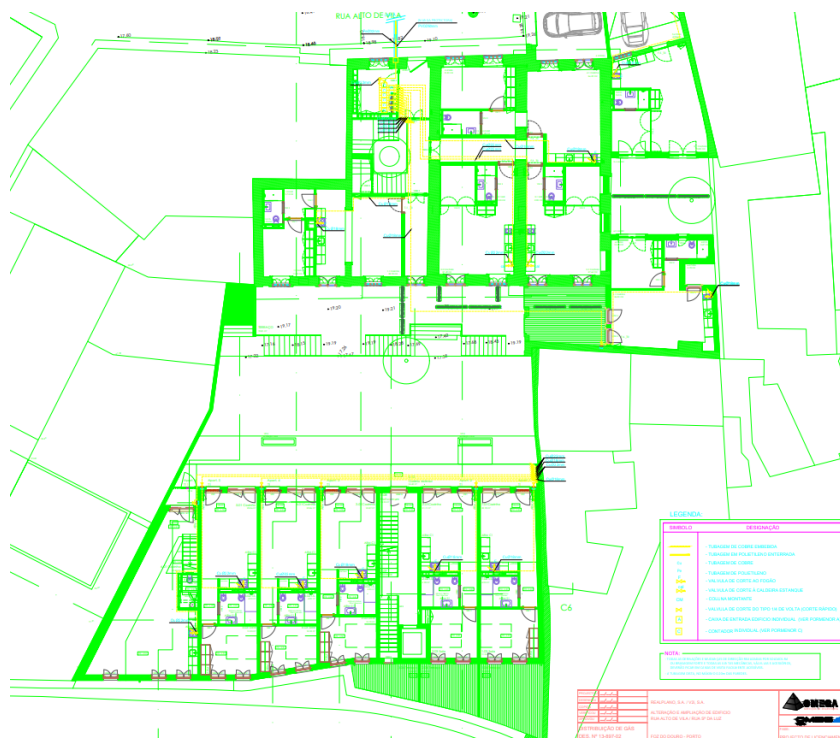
Projeto de gás Casa Ferreirinha piso 0 e 1.
